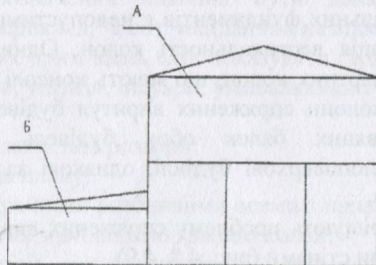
Зовнішній поперечний вигляд двох спряжених впритул повздовжніми стінами будівель: А – двоповерхова будівля з сіткою колон 6х6, висоти поверхів – 6 м; Б – одноповерхова будівля прогоном 9 м і заввишки 3 м
